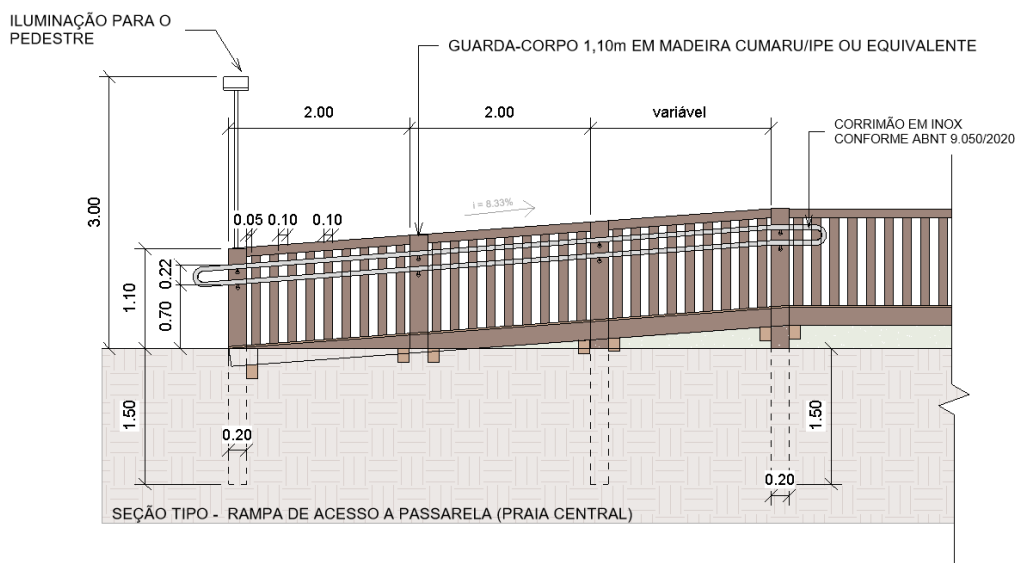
DETALHE DOS MÓDULOS CONSTRUTIVOS DAS RAMPAS DE ACESSO.....	46
